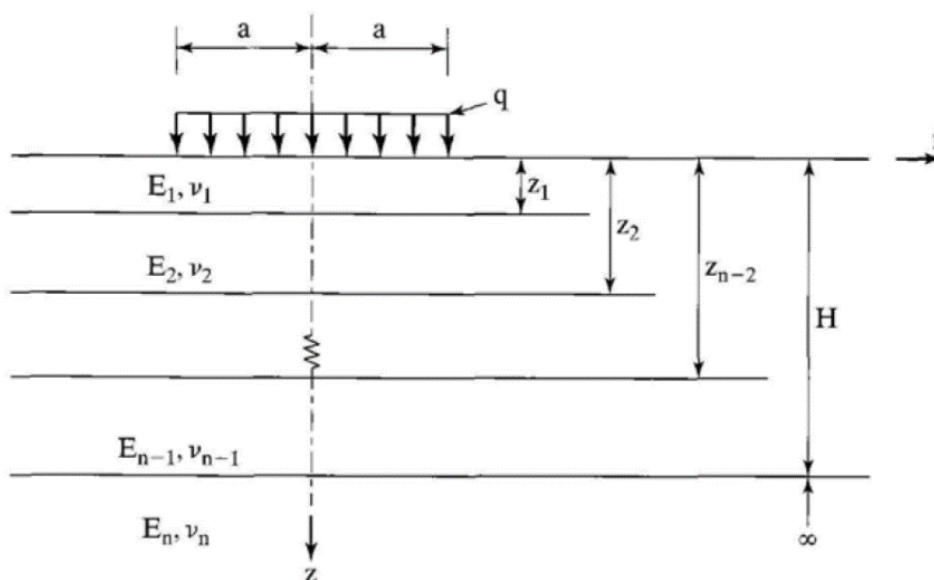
2. Schematizzazione della pavimentazione come multistrato elastico.
